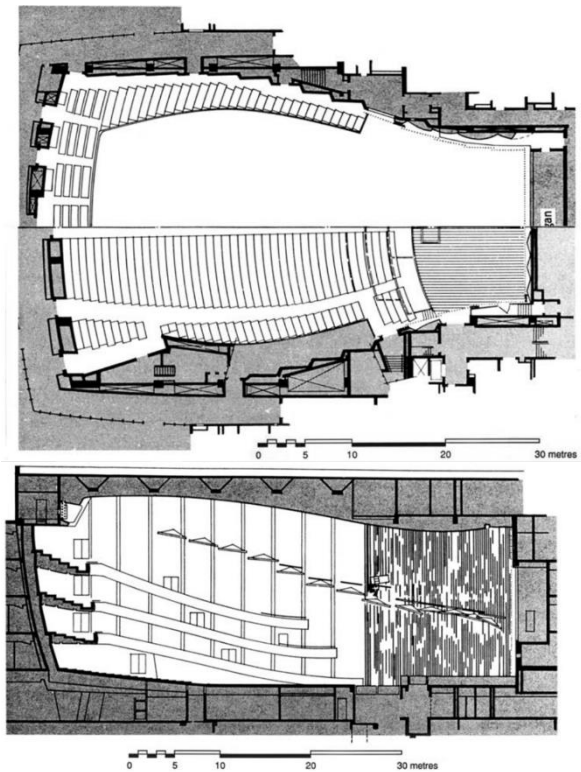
New York Filarmonic Hall antes das renovações, planta e corte (Barron, 2009)
